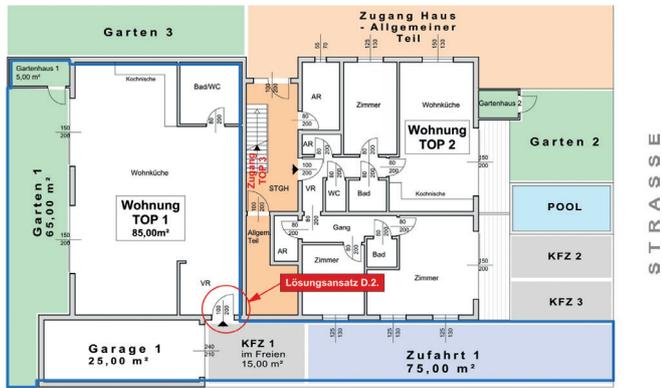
Grundriss zu Fallbeispiel D.2
